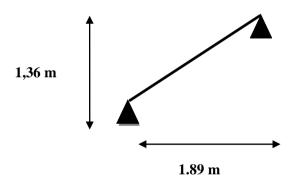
Schéma d'escalier type 1 niveau RDC 1.
